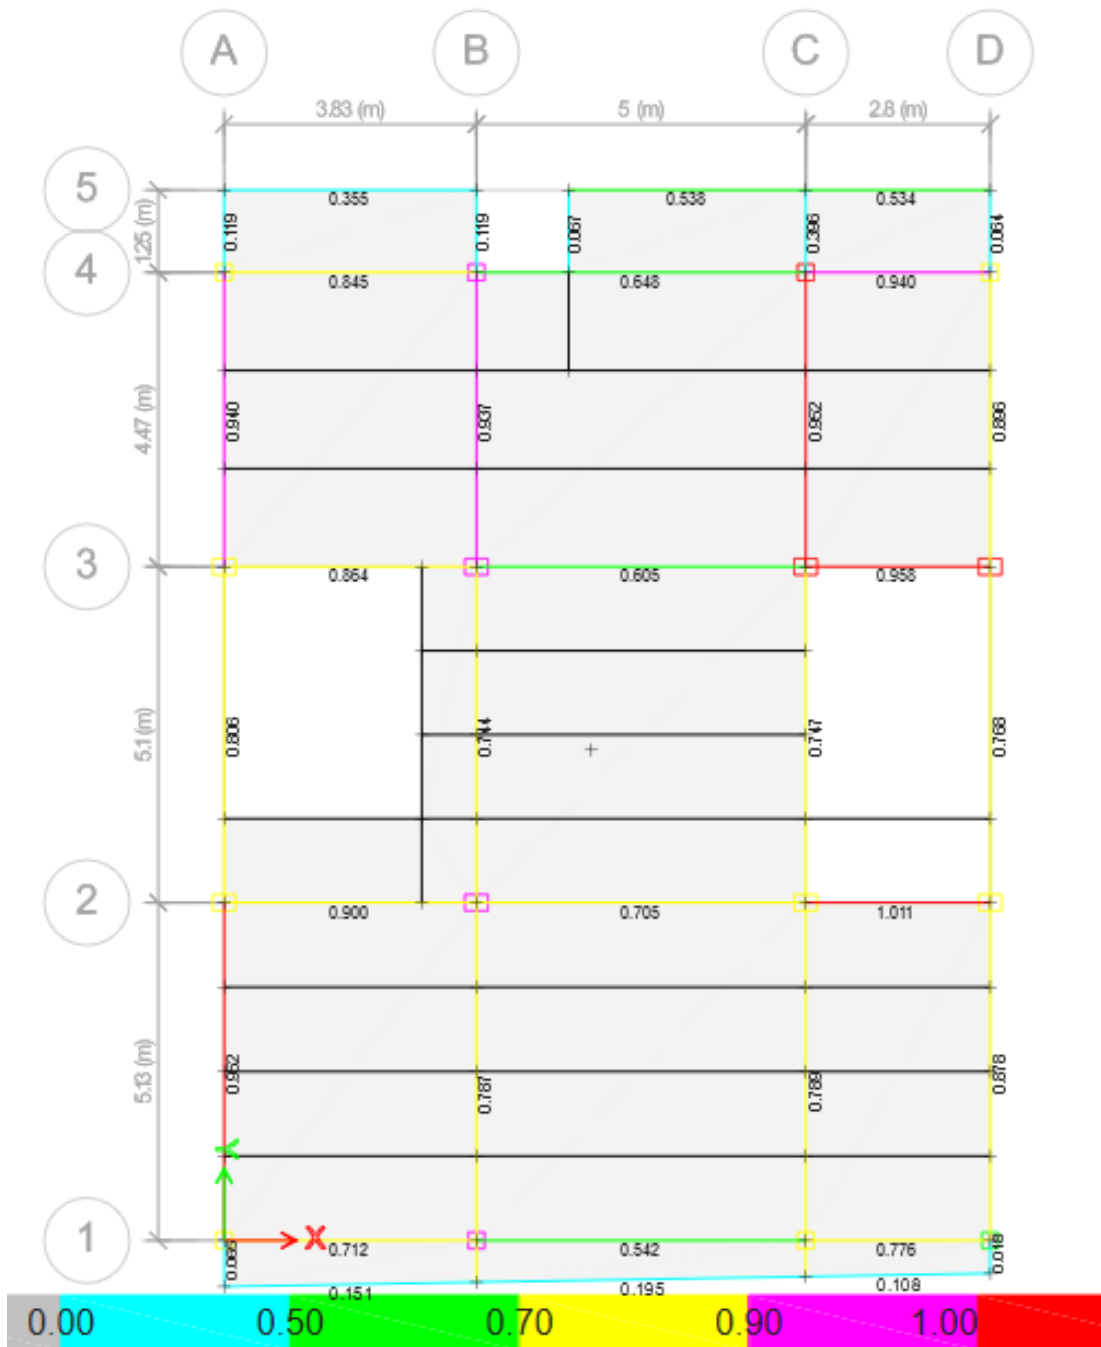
Vista en planta Nv.+3,24 de secciones principales, con diseño AISC 360-16 demanda/capacidad
